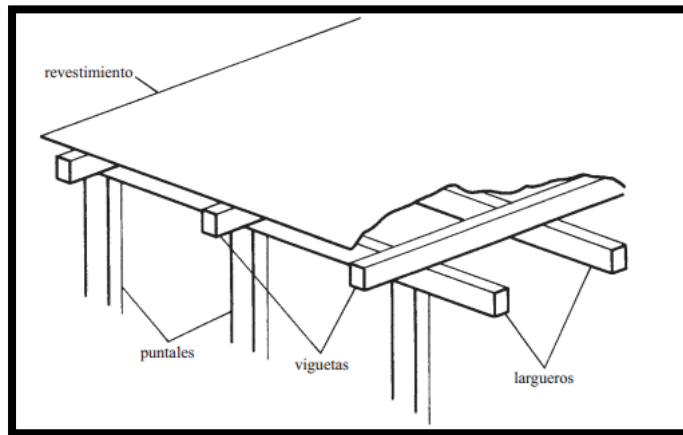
Detalle de encofrado para losas de entrepiso (Fuente: McCormac, Jack C., Brown, H. Russell, Estados Unidos (2011). "Diseño de Concreto Reforzado", Capítulo 20, Sección 20.7, Figura 20.1)
